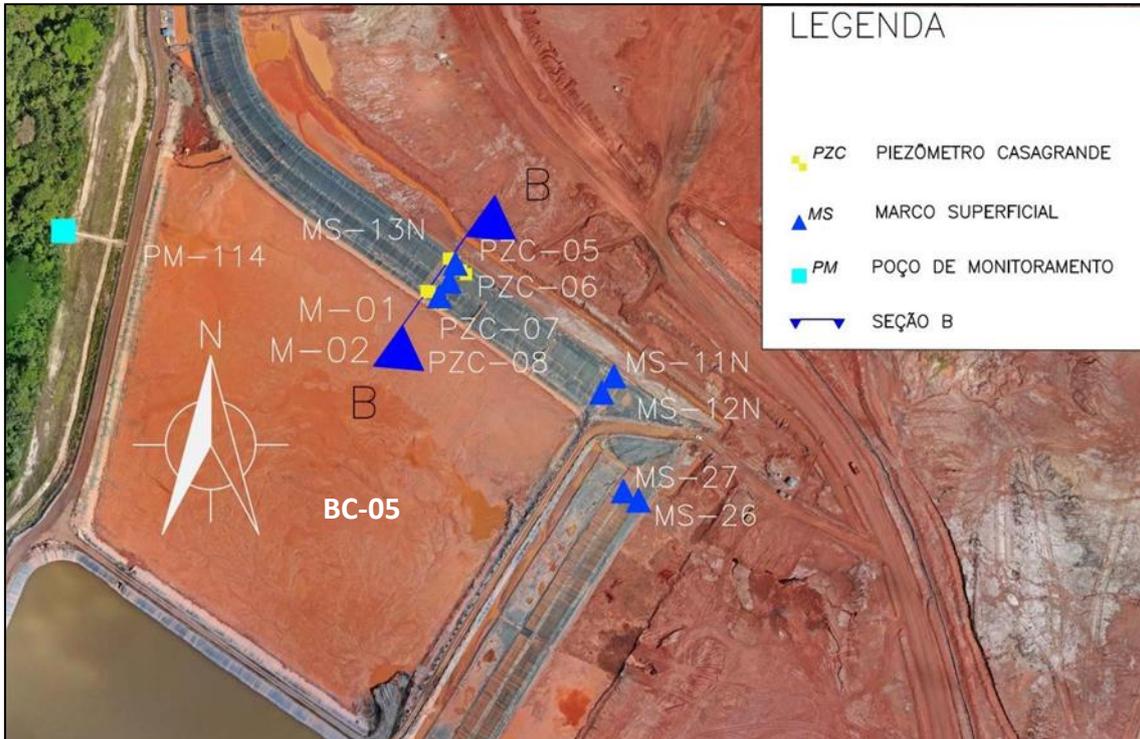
Localização em planta da instrumentação instalada na Seção B (PIMENTA DE AVILA, 2022)
